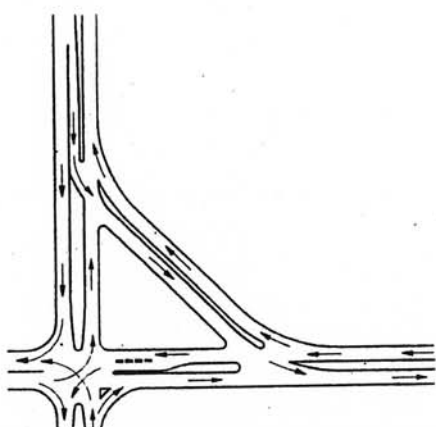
GIRO A LA IZQUIERDA SEGREGADO DEL CRUCE
